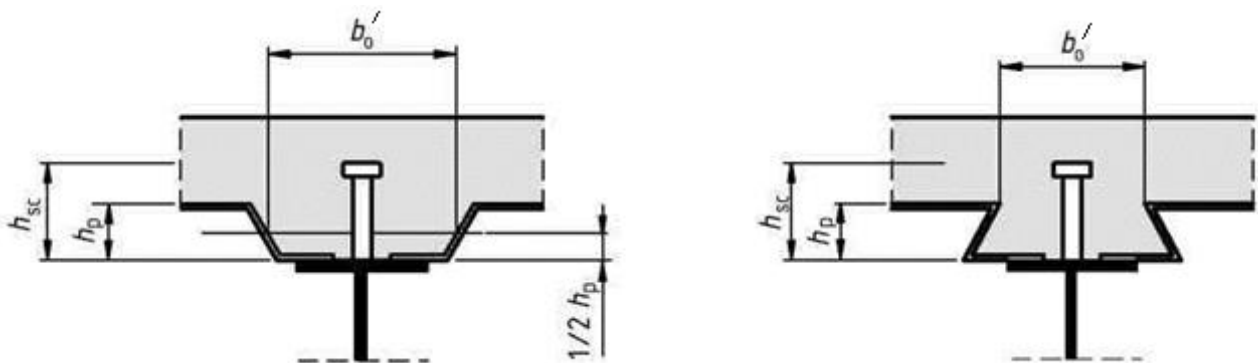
Балка з профільованим настилом, орієнтованим гофрами паралельно балці
